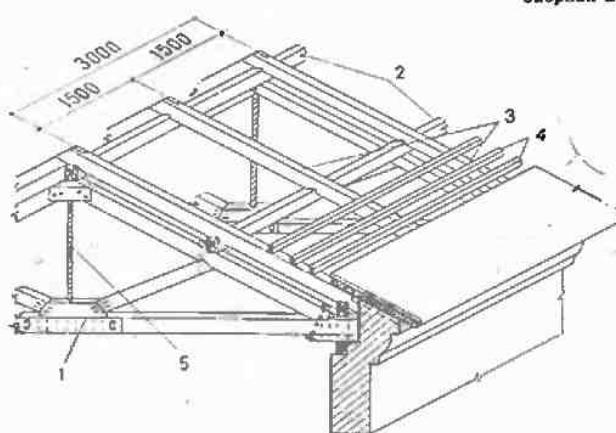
Укладка прогонов по верхнему поясу стропильных ферм
